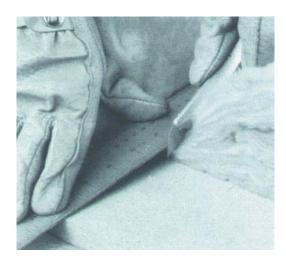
Corte del aislante térmico para su correcta colocación.
